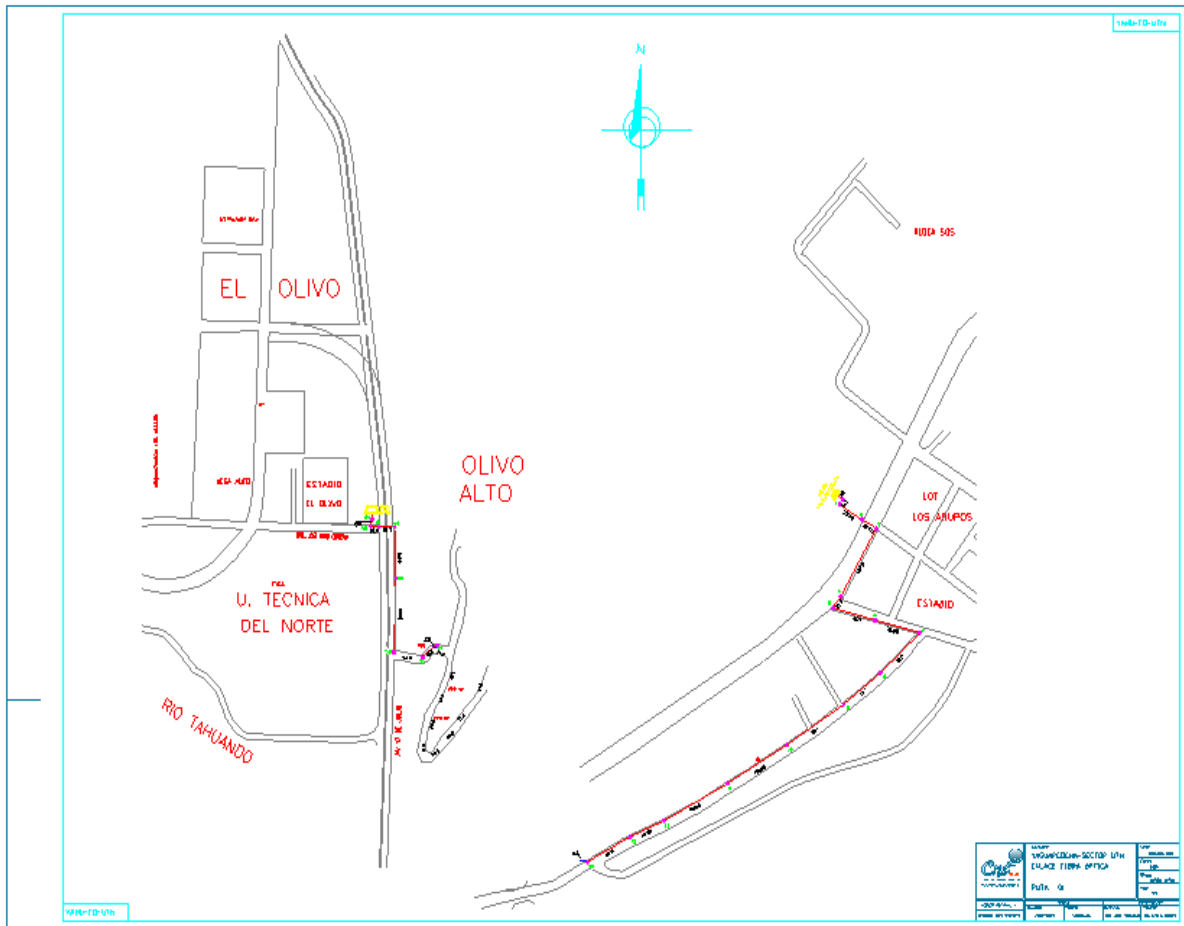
Plano de la canalización construida tanto para los enlaces de Fibra Óptica y red primaria.
